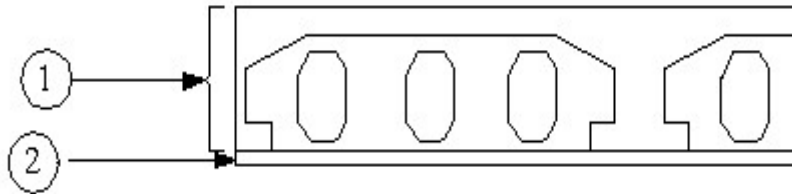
Coupe du plancher local ascenseur (corps creux).
